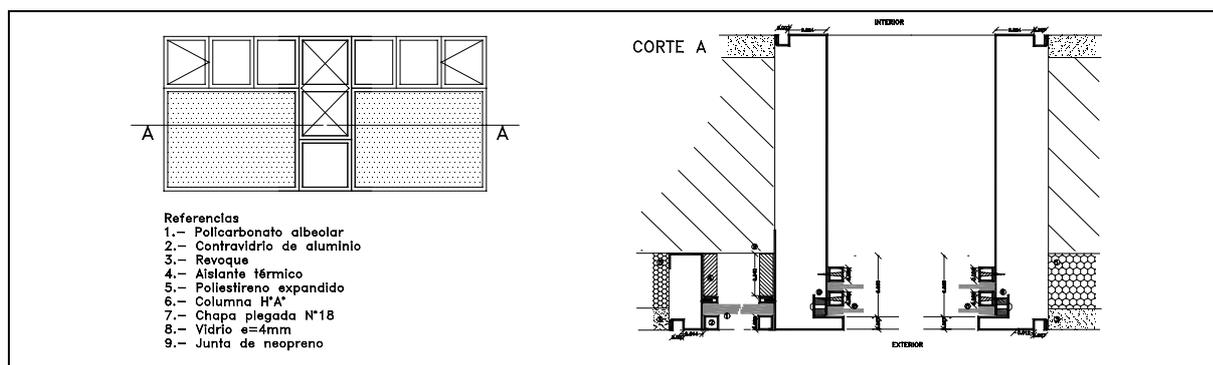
Vistas y corte del conjunto Ganancia Directa y Muro Solar.
